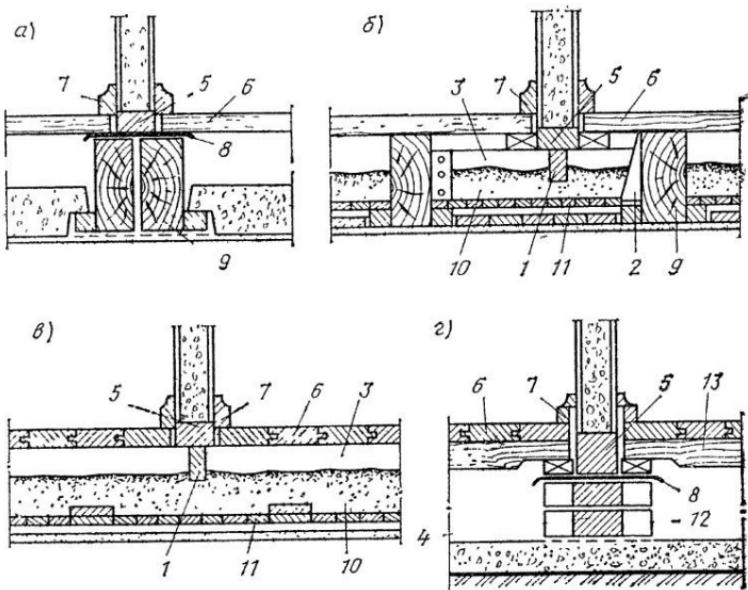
Звукоизоляция перегородок на междуэтажном перекрытии на первом этаже
